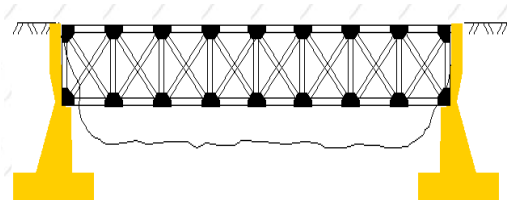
Puente con armadura metálica inferior tipo Bayley.
